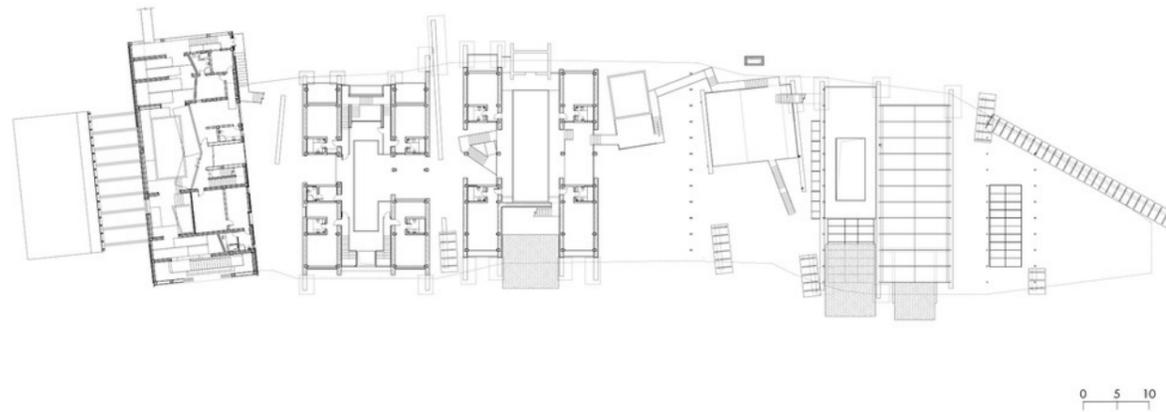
132. Planta segunda del proyecto. (Imagen extraída en red: área-arch.it).
